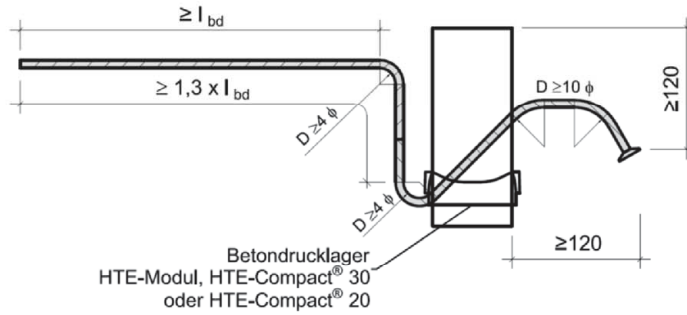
Querkraftstab für Schöck Isokorb® Typ K-U, K-U-F, K-O und K-O-F
